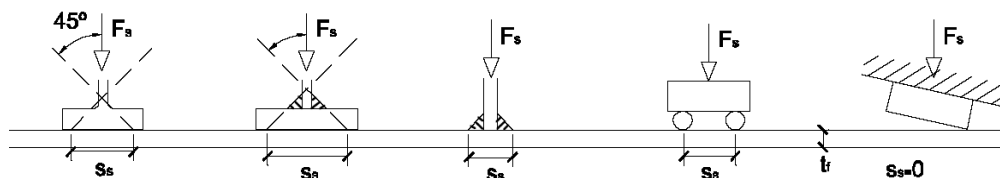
Ancho de entrega rígida en el perfil HEB-160
